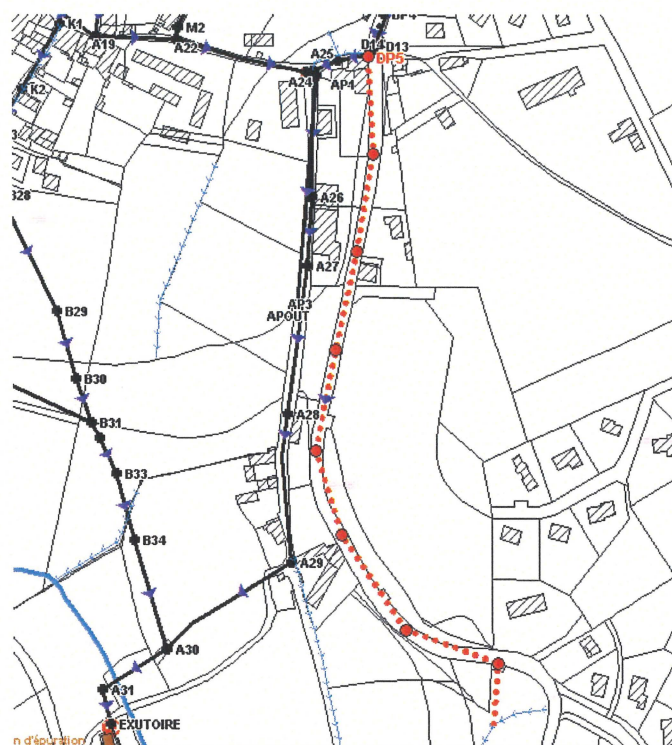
Construction d'un réseau pluvial en continuité du réseau pluvial de la branche D.
